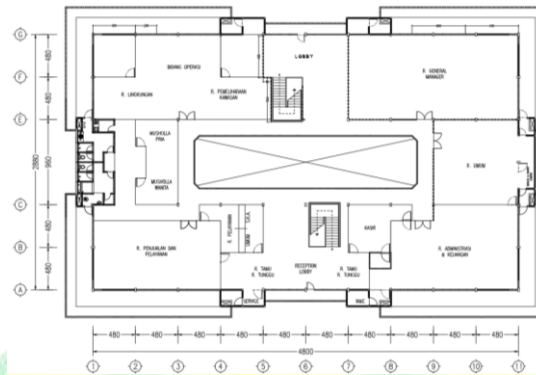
Denah Lantai 1 Kantor Unit PT. KBN Cakung
